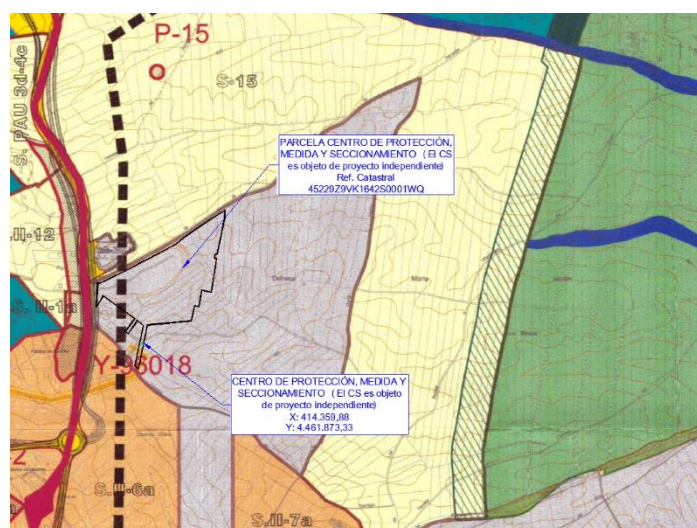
Plano de Ordenación (Plano o.01.2 Junio 2009)
